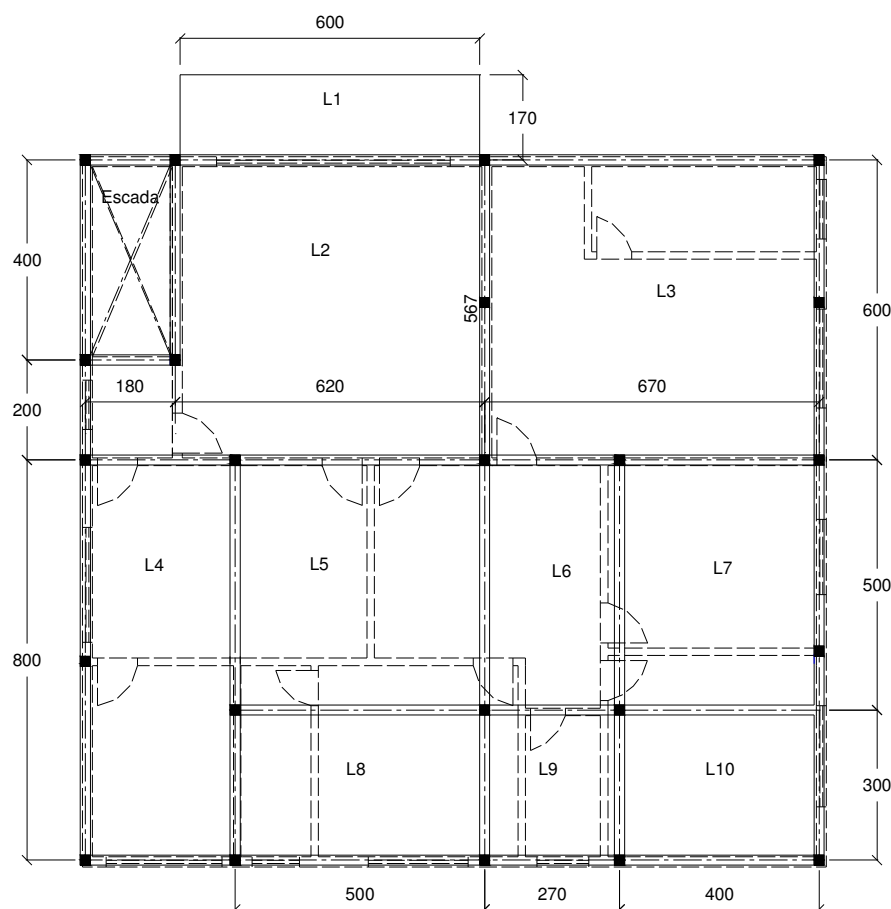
Paredes sobrepostas na planta de fôrma da estrutura.
